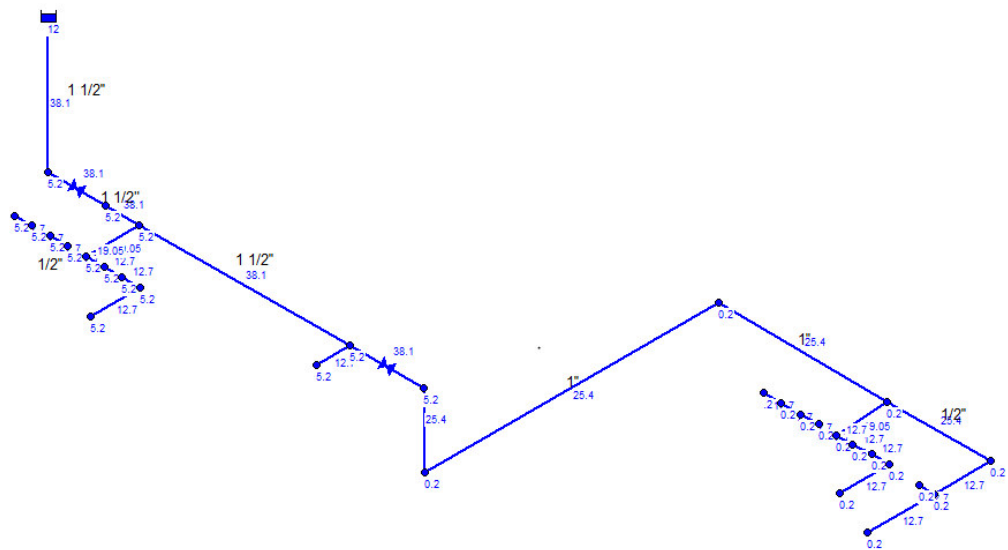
Cotas en los nudos (m) y diámetros de tuberías (mm)
